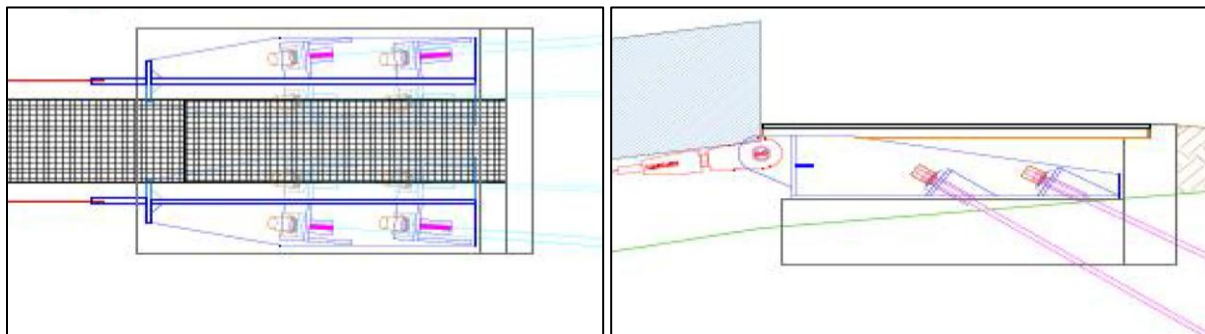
beispielhafter Grundriss (links) und Schnitt (rechts) der erforderlichen Widerlager (unmaßstäblich)¹²
